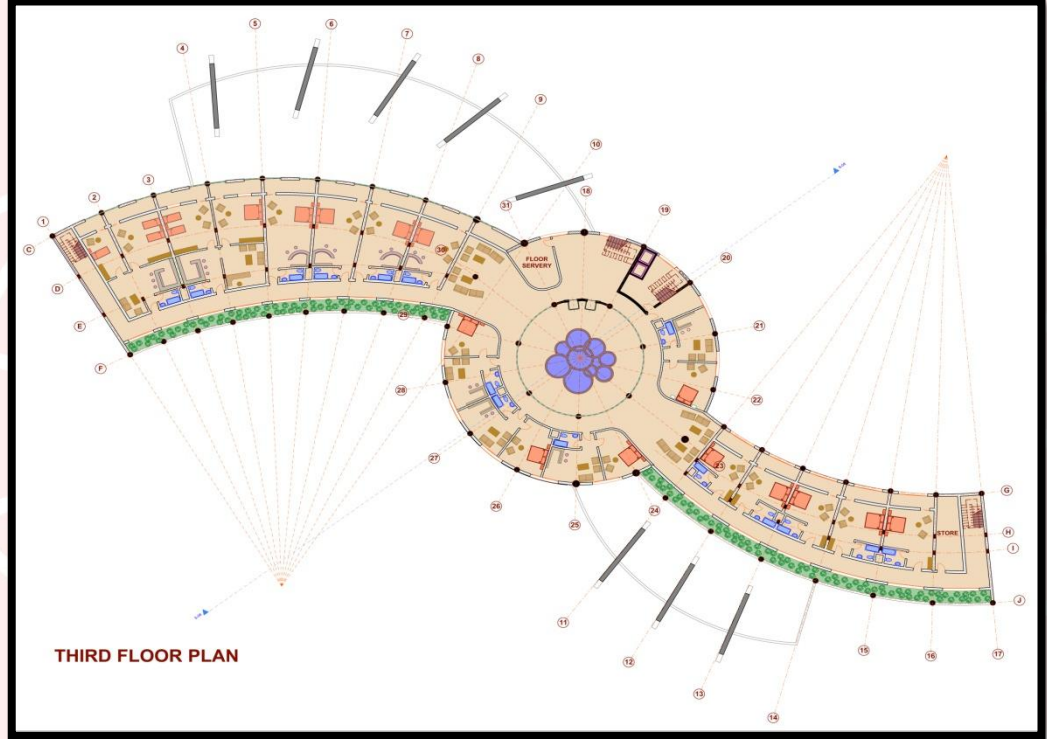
المسقط الأفقي للطابق الخدمي للفندق
